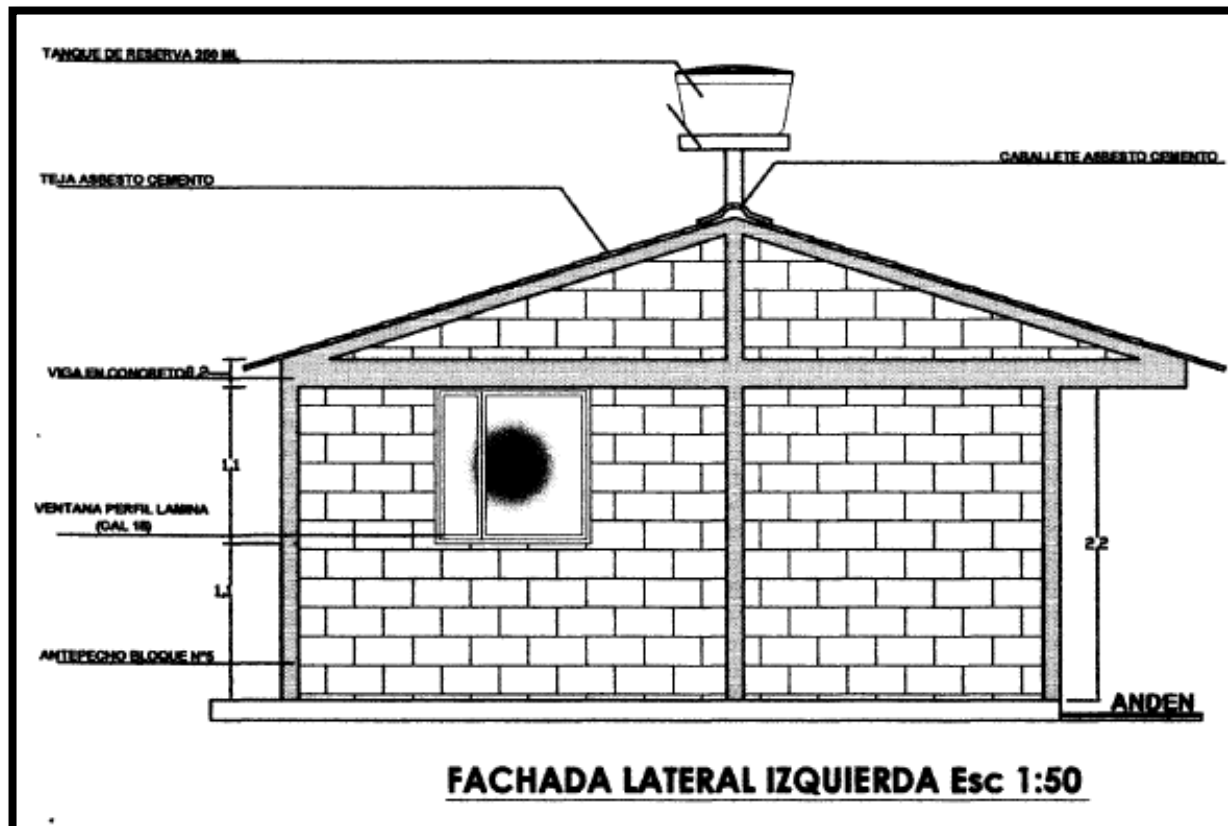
Diseño arquitectónico. Fachada lateral. Fuente: FEDECAJAS
